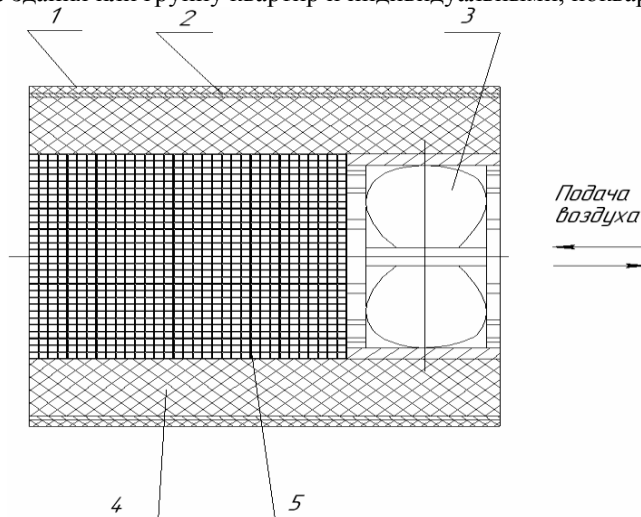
Конструкция регенеративного теплообменника с периодически изменяемым направлением прокачиваемого воздуха: 1 - корпус регенератора; 2 - теплоизоляционная фольга; 3 – вентилятор; 4 – теплоизоляция; 5 - регенеративная насадка.
